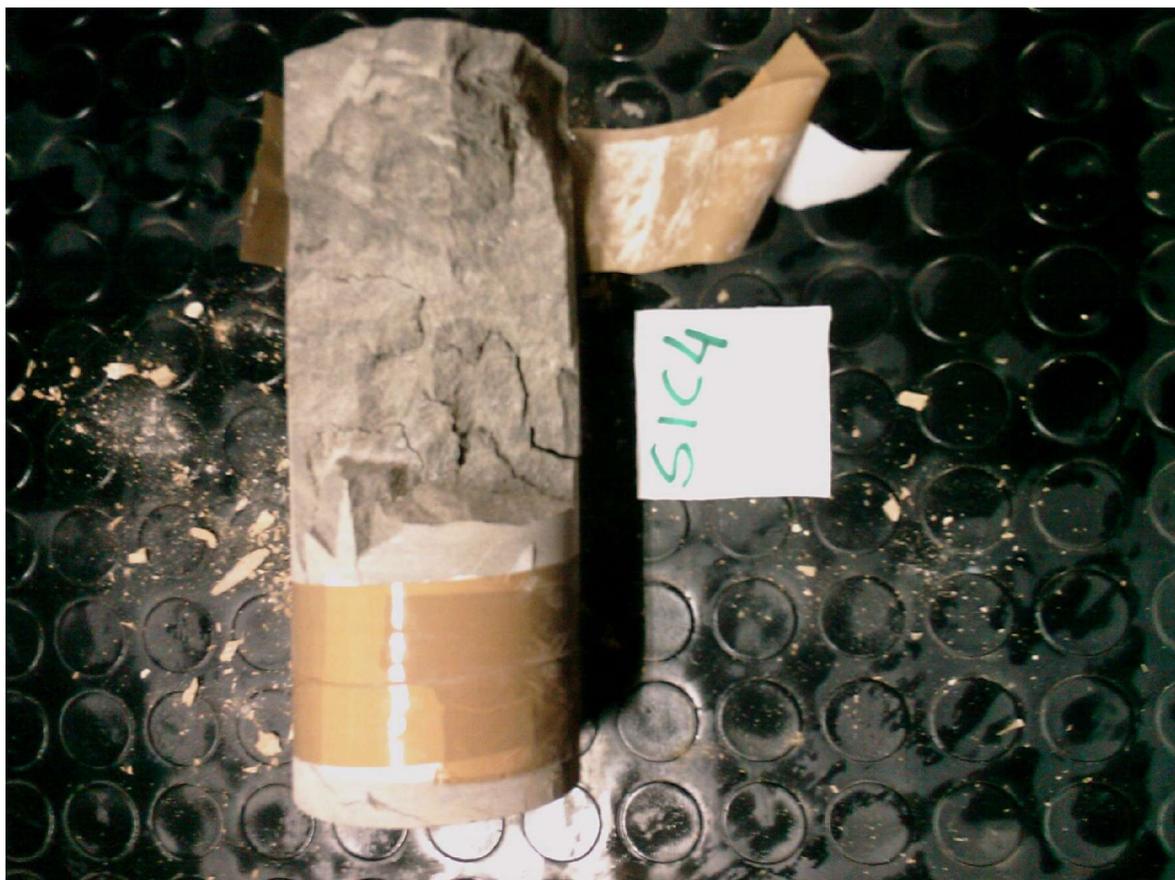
Particolare prova di schiacciamento campione S1C4.
